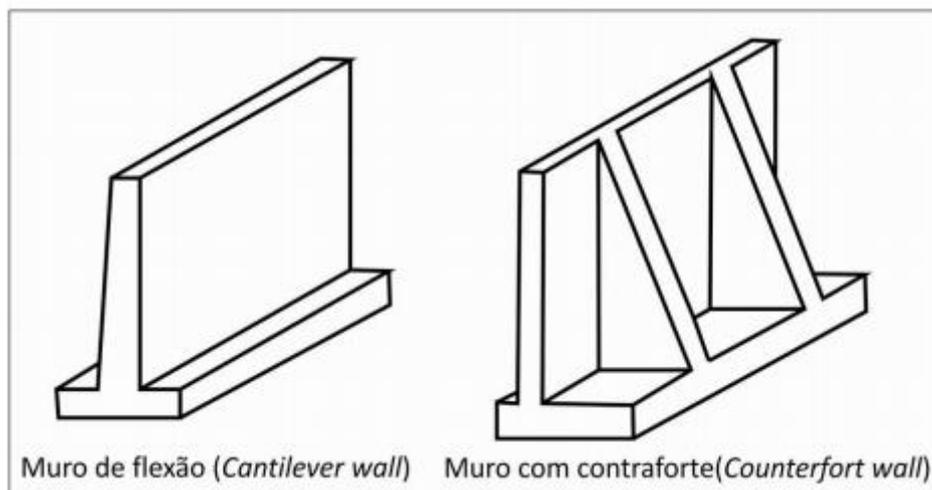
Esquema da estrutura dos muros de flexão e com contraforte
